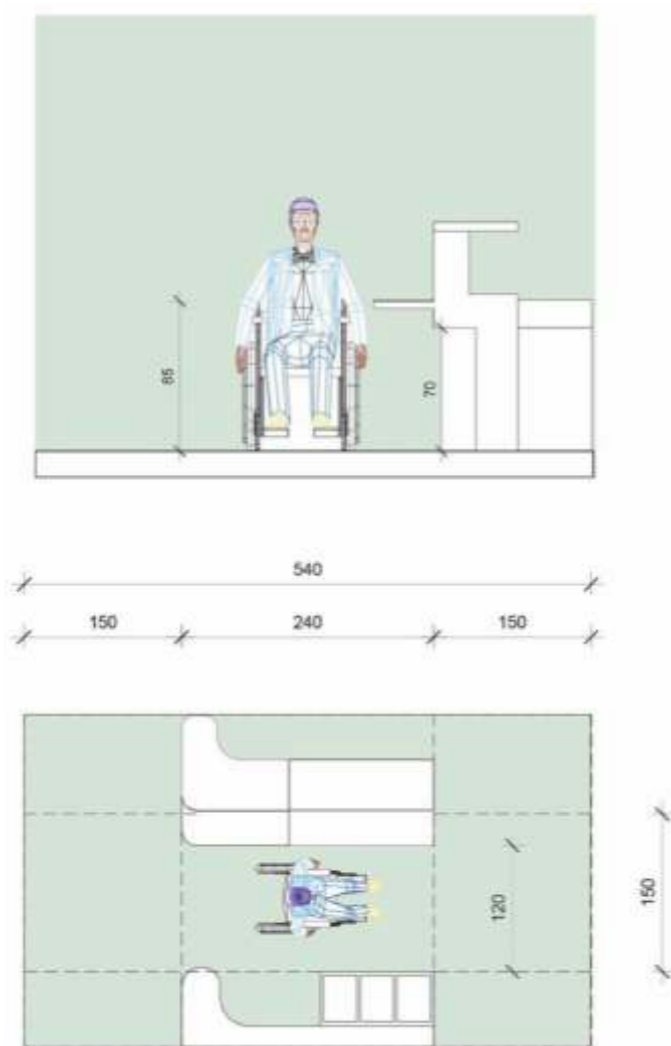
Planimetria dhe dukja me përmasa të sportelit të qasshëm
